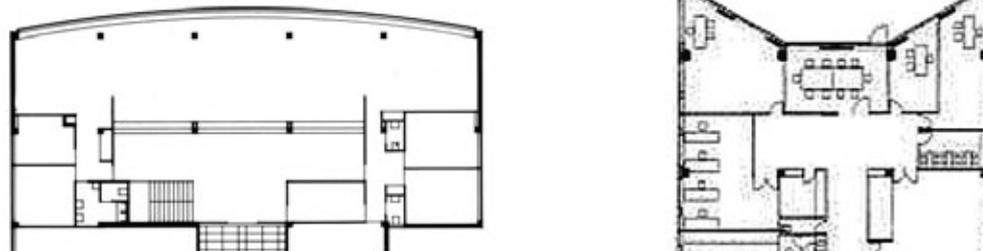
Forma de fachada posterior en planta del Gobierno Civil e Institutos de Investigación.
